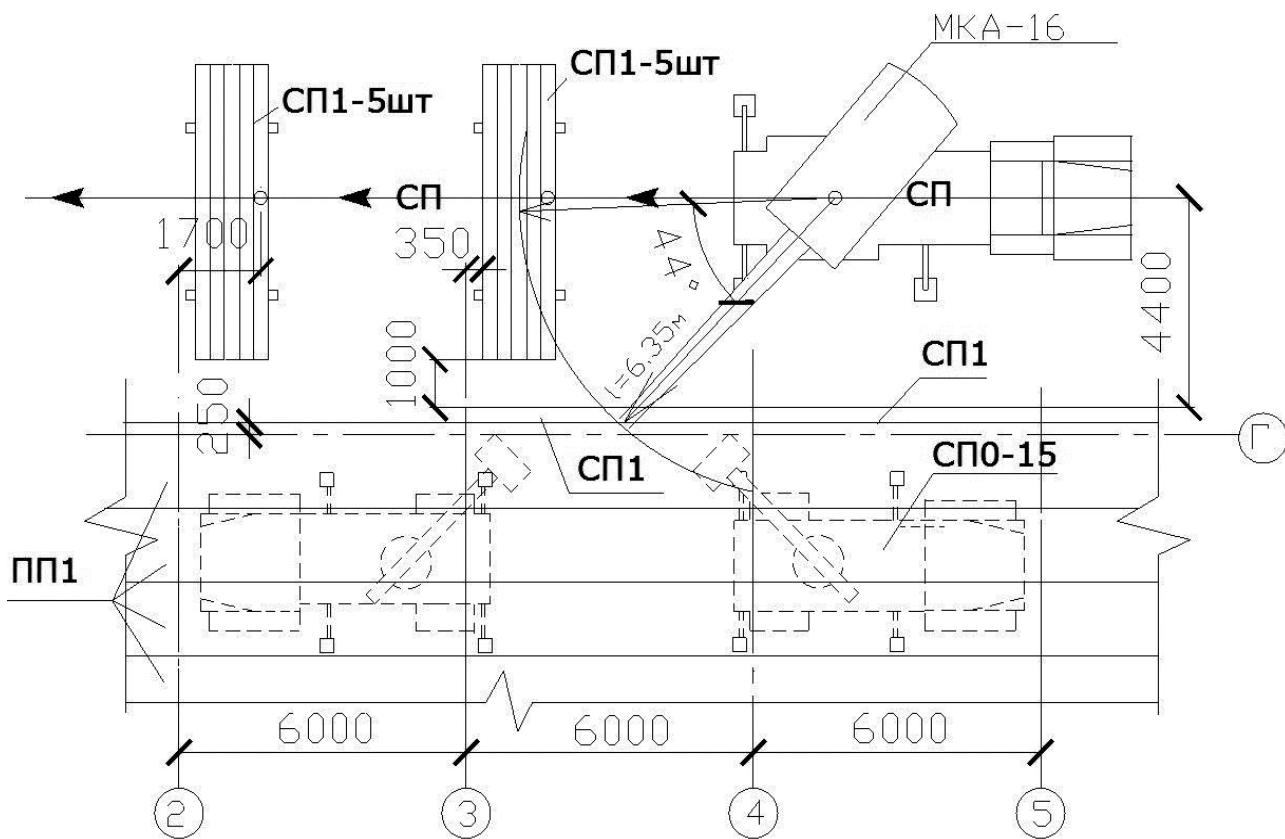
Схема монтажа железобетонных стеновых панелей поворотом крана без изменения вылета стрелы
